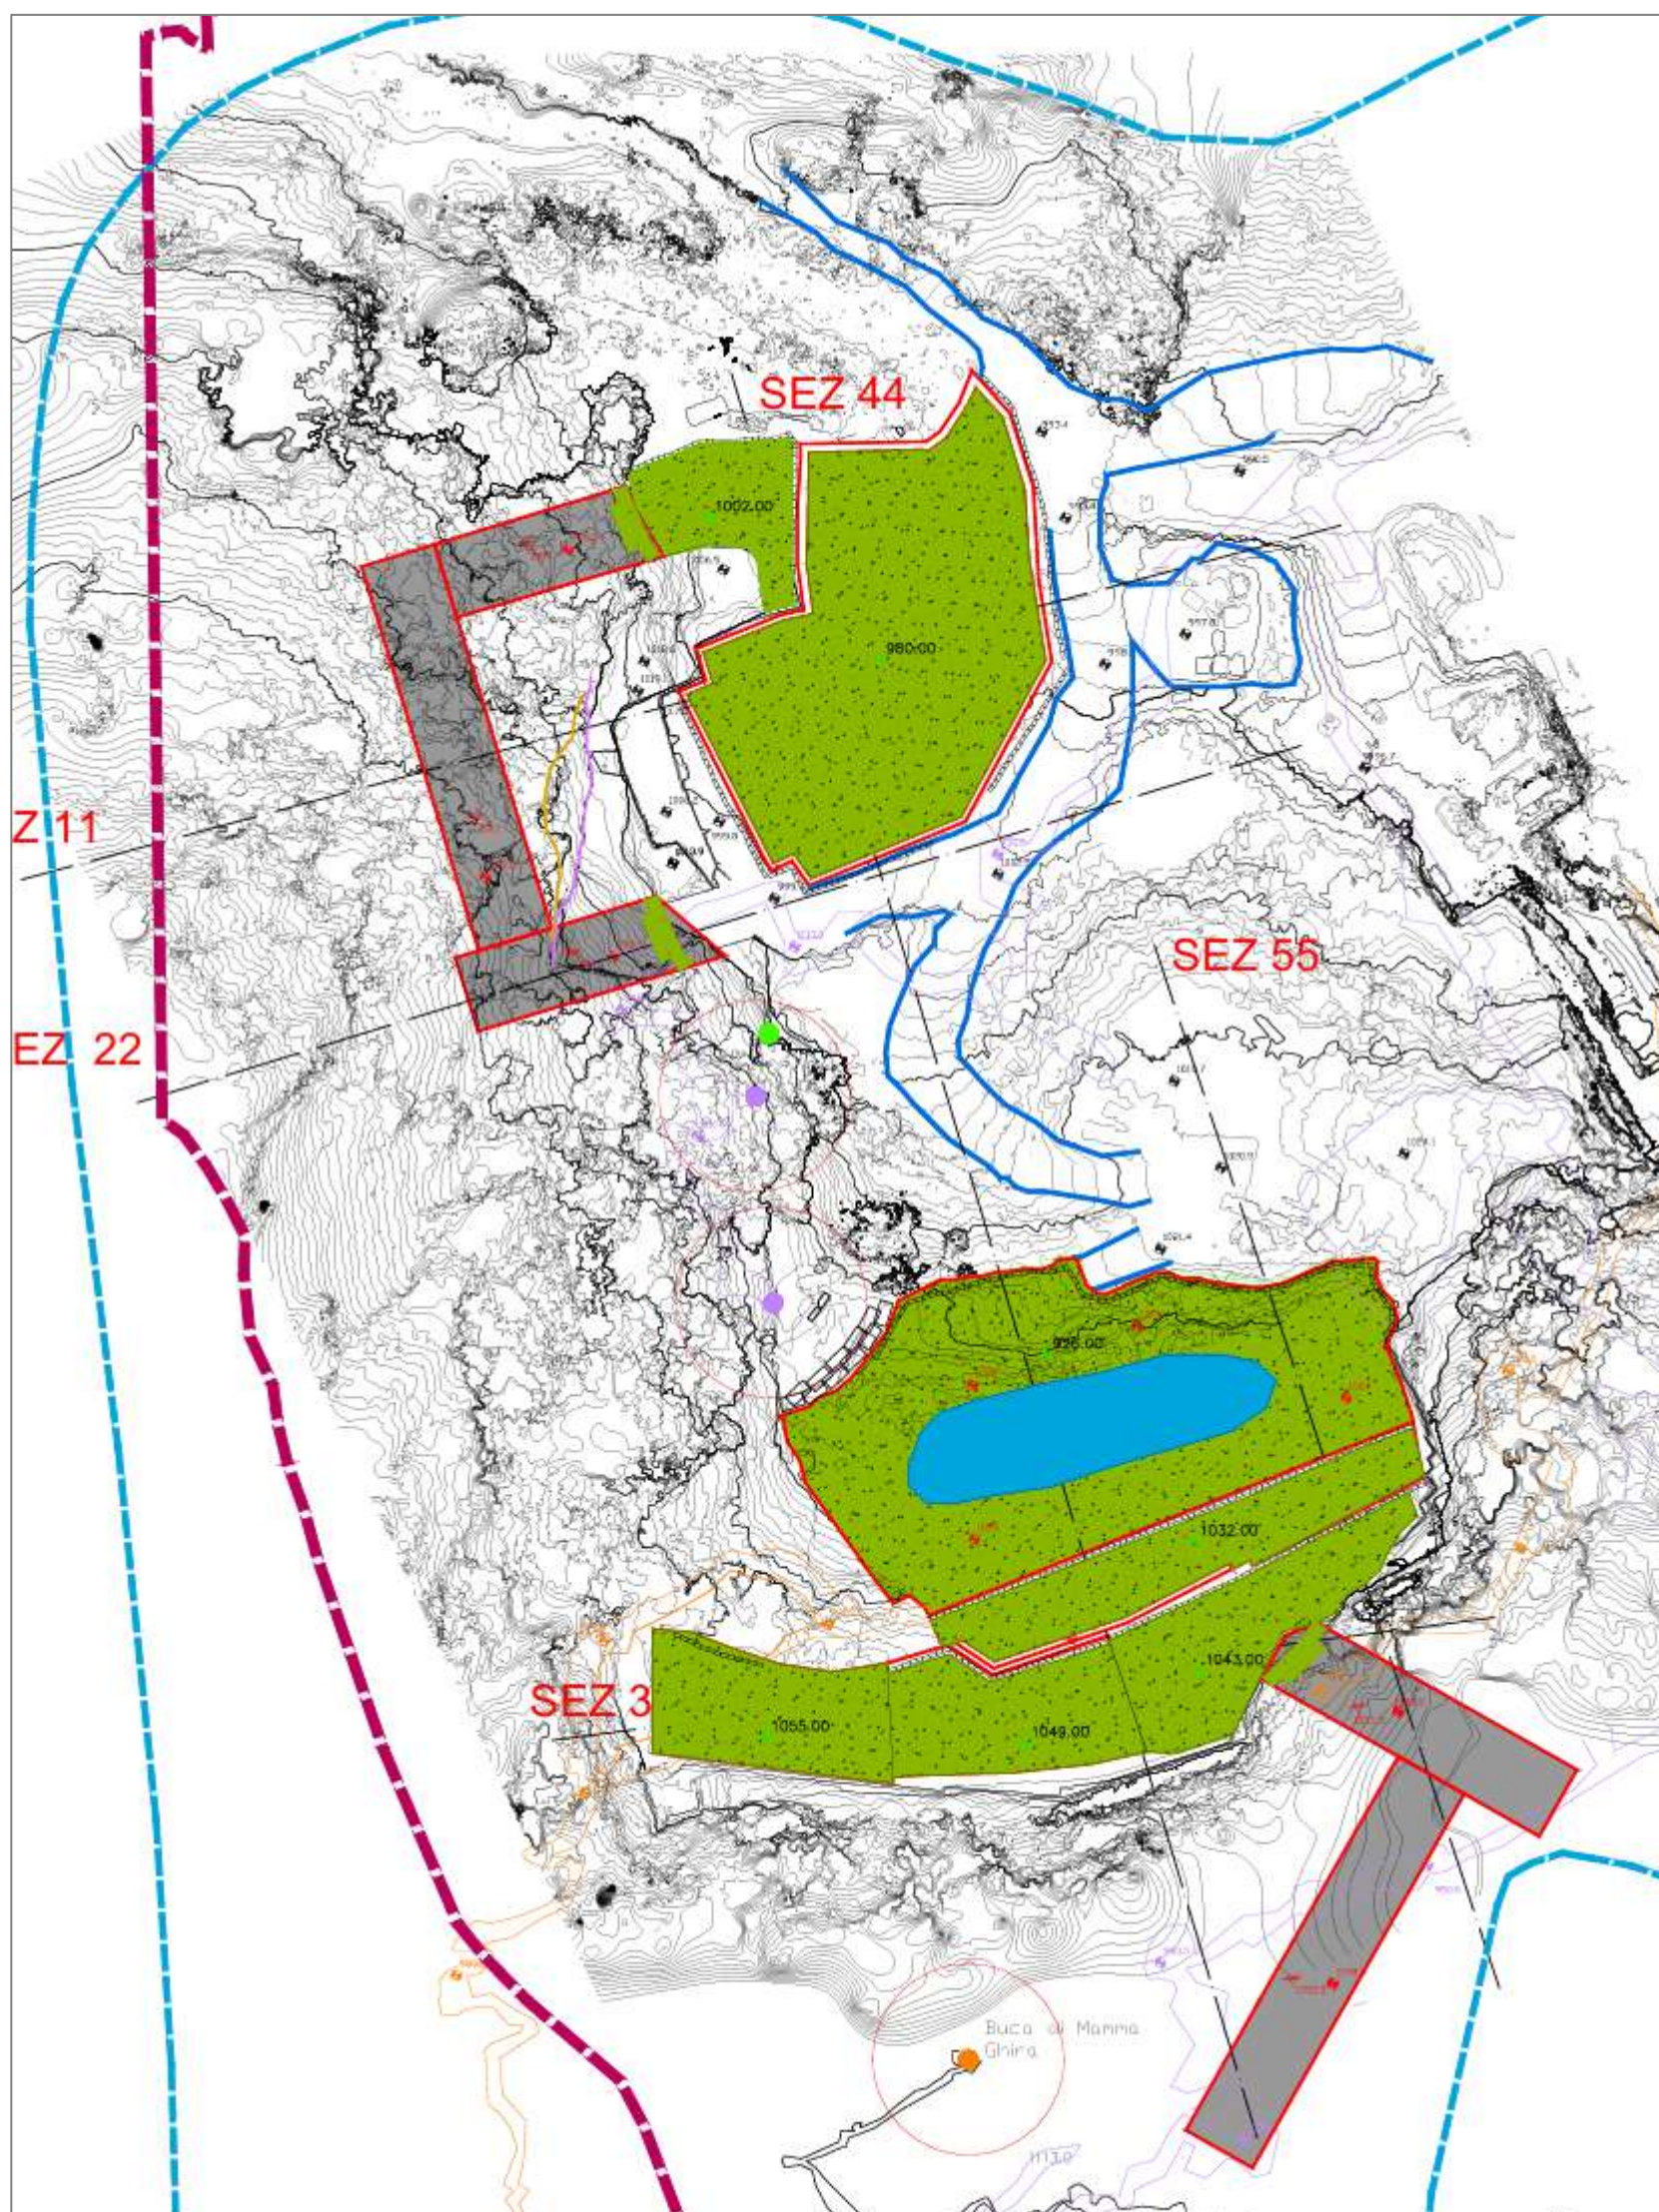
Planimetria risistemazione e reinserimento ambientale (Tav. 11.1).
